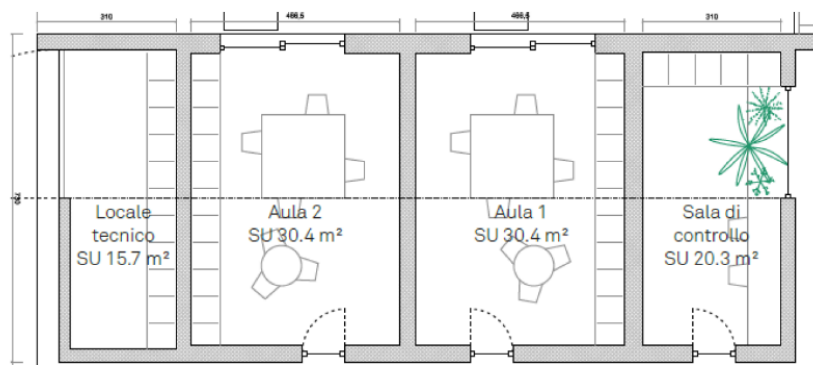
VISTA IN PIANTA DEL MODULO ABITATIVO PVZEN [10]
